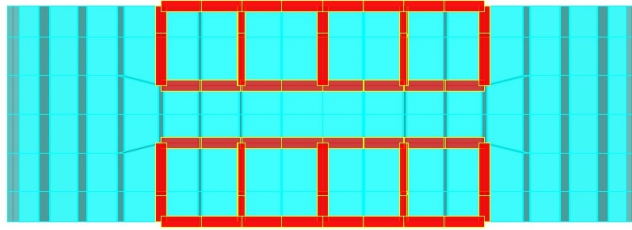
Vista in pianta estrusa della chiave dell'arco e arco stesso
